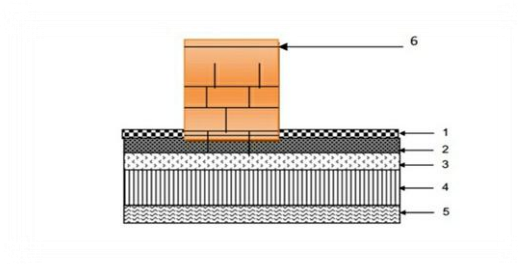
Coupe verticale d'un plancher terrasse inaccessible
